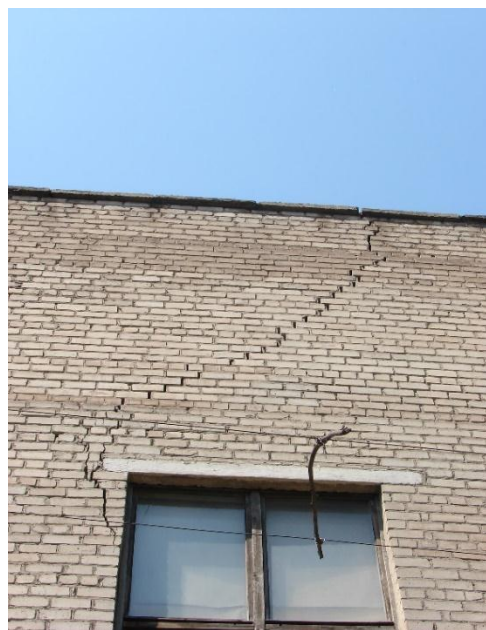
Тріщина шириною розкриття до 1 см у верхній частині стіни лівого бічного фасаду будівлі
